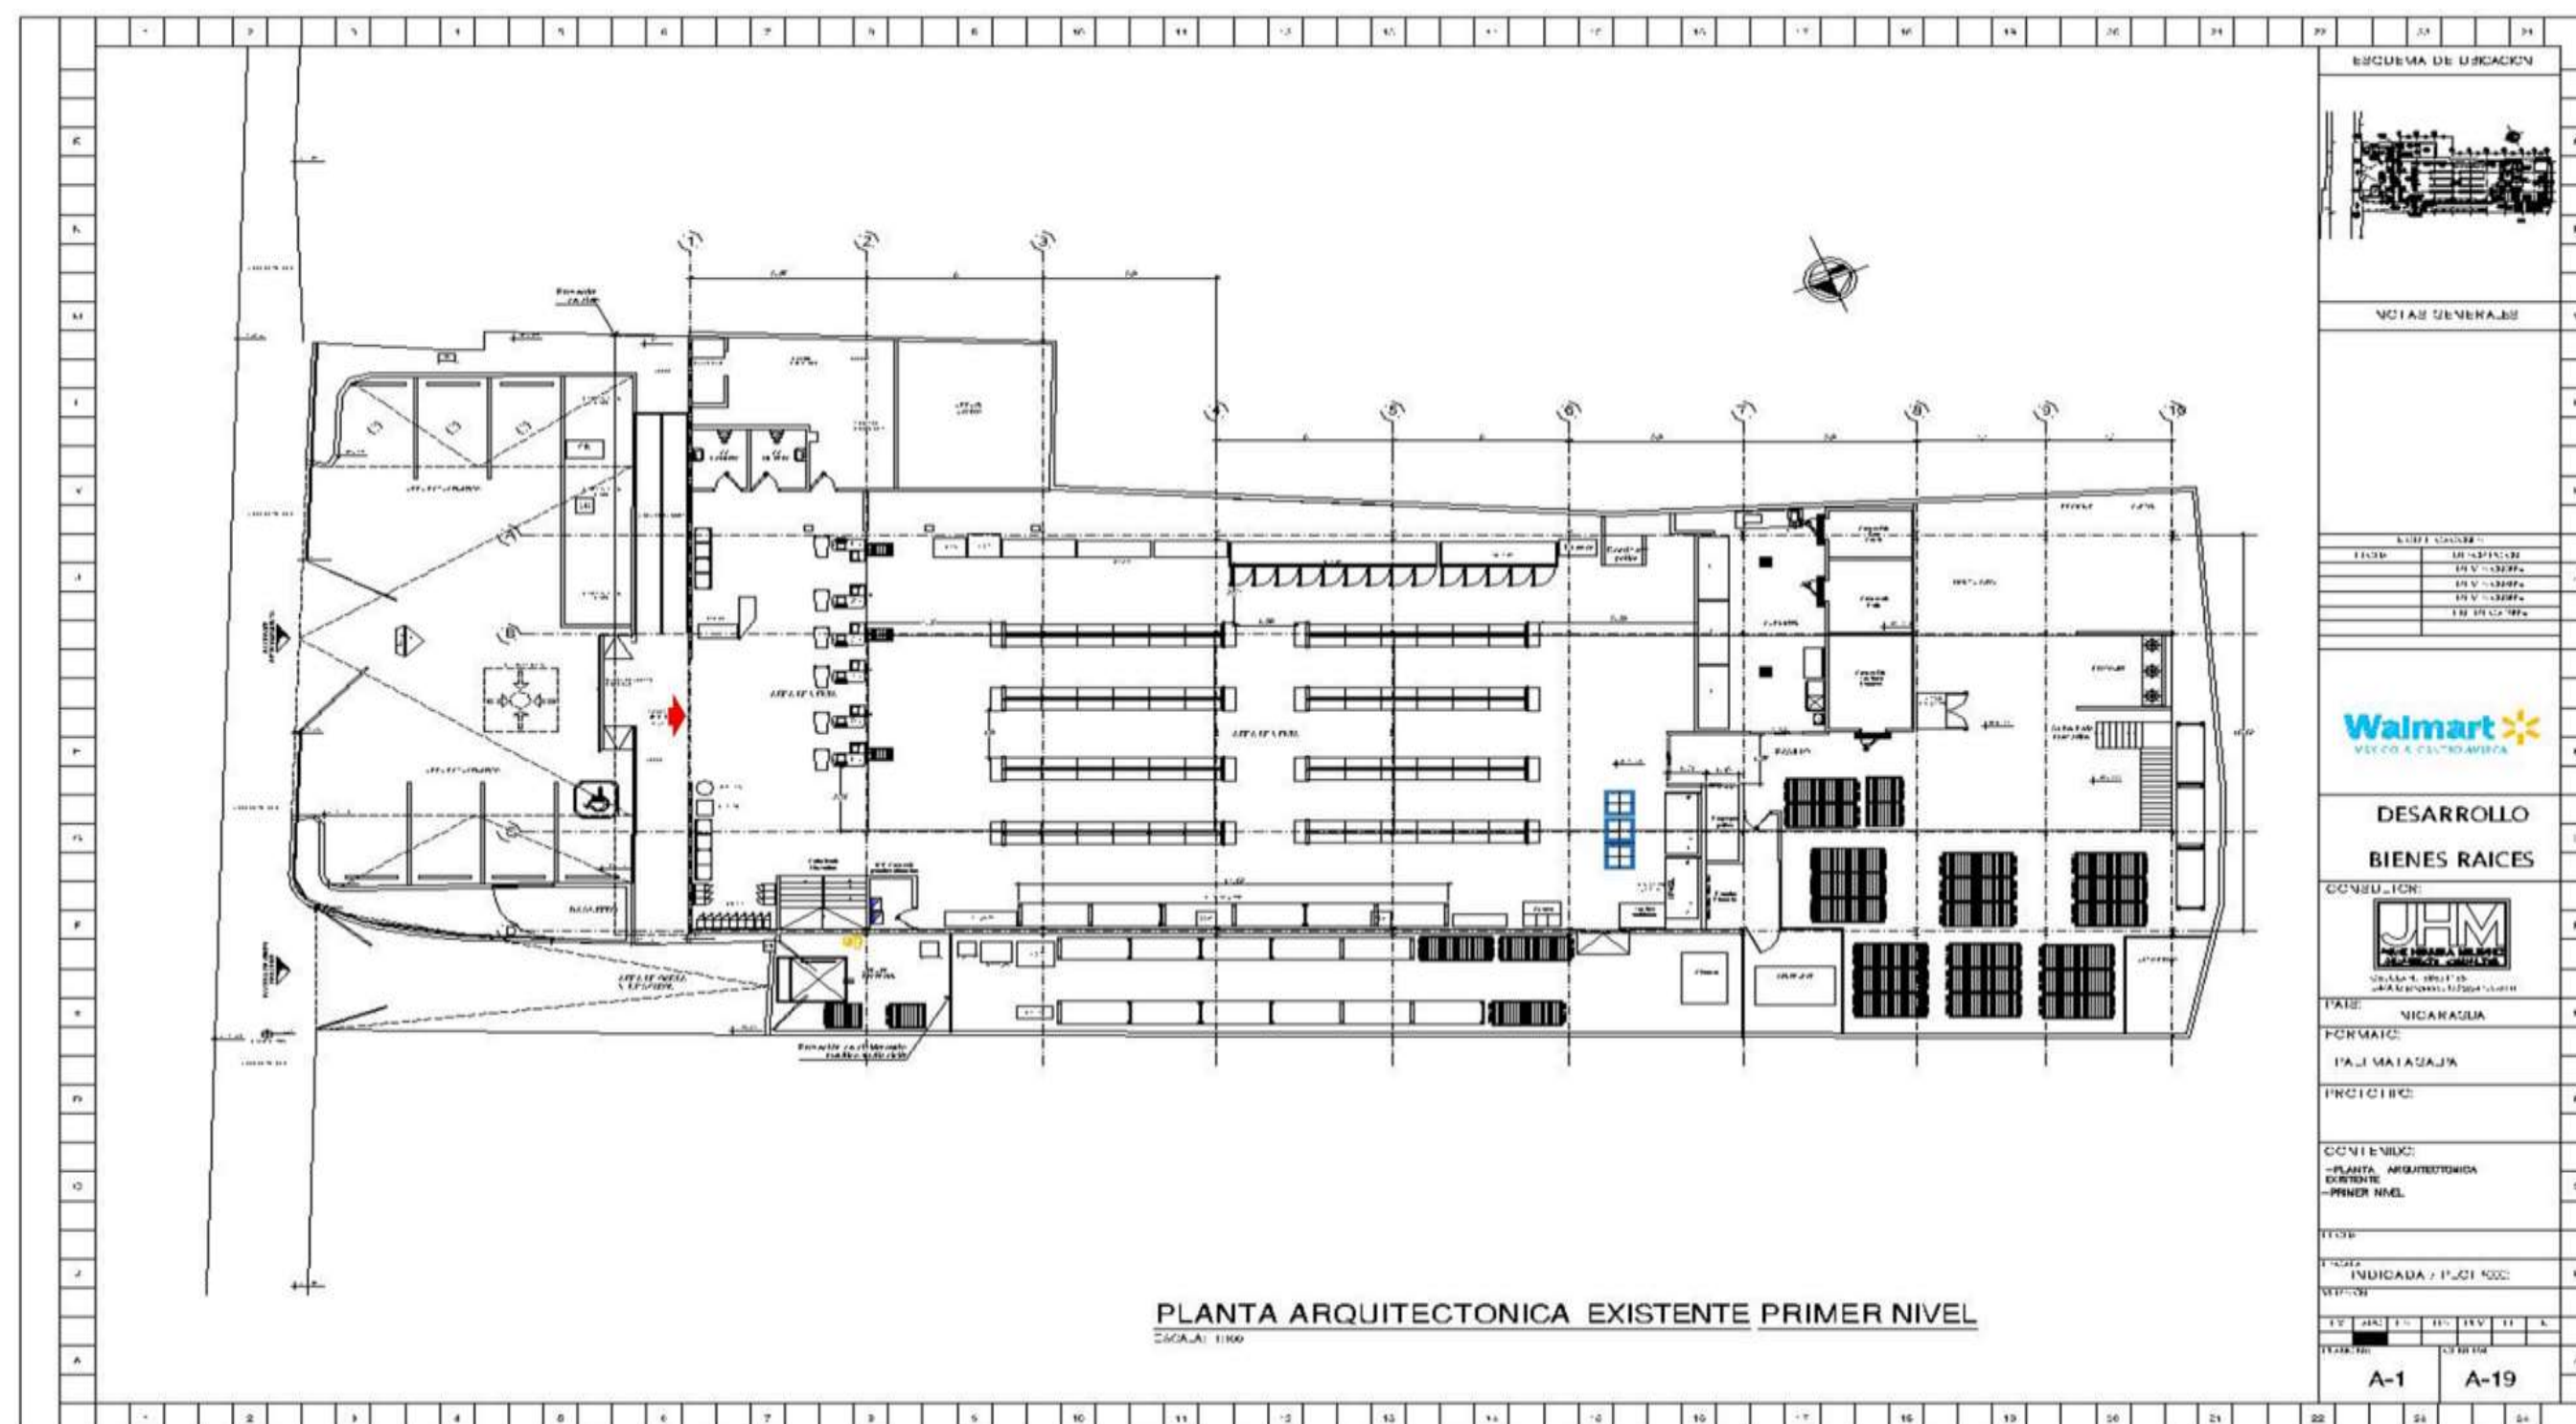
Plano del Primer Nivel del Edificio. Fuente: Elaboración Propia.
